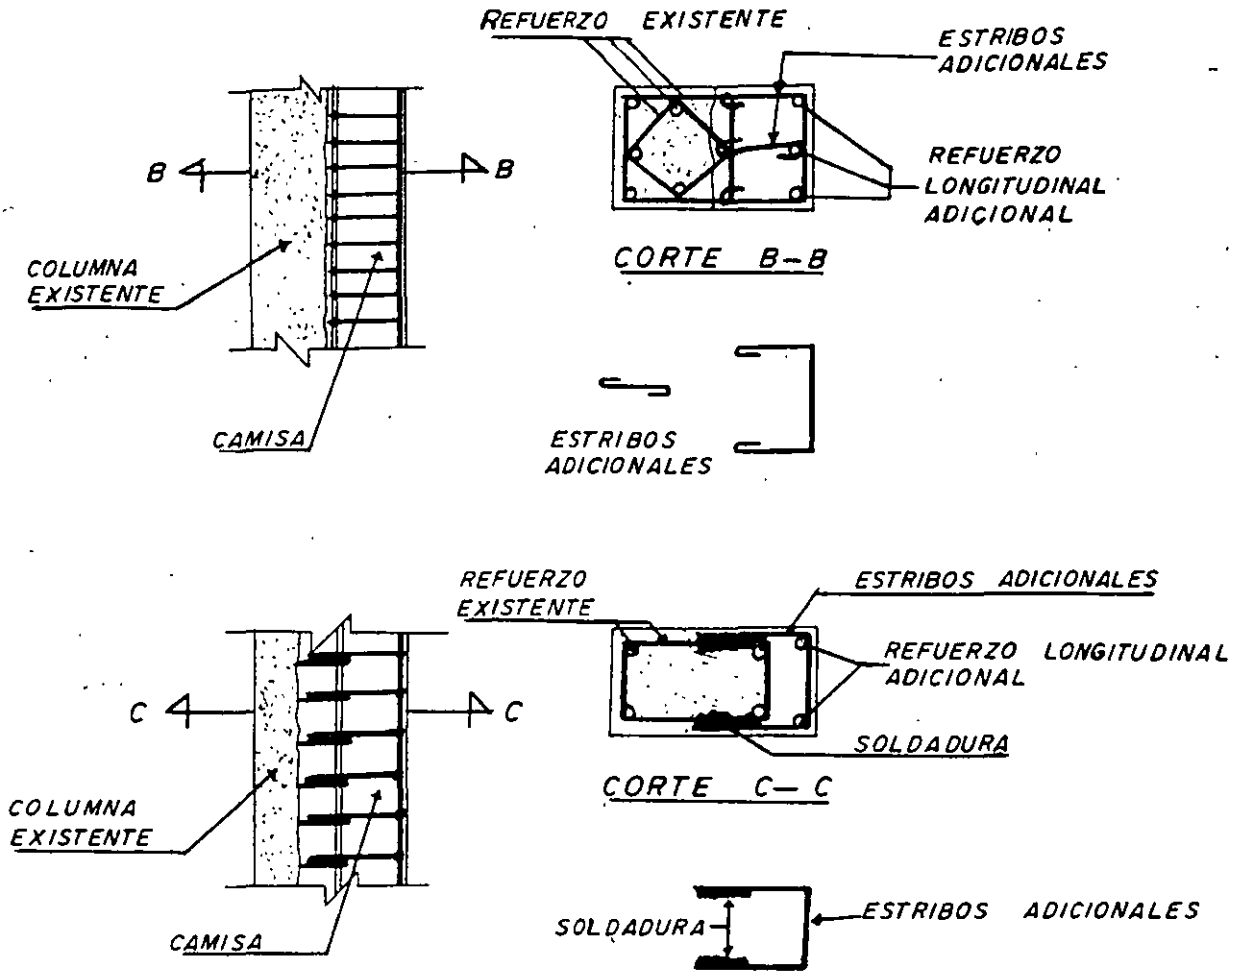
Técnicas para encamisado de columnas con concreto reforzado.
